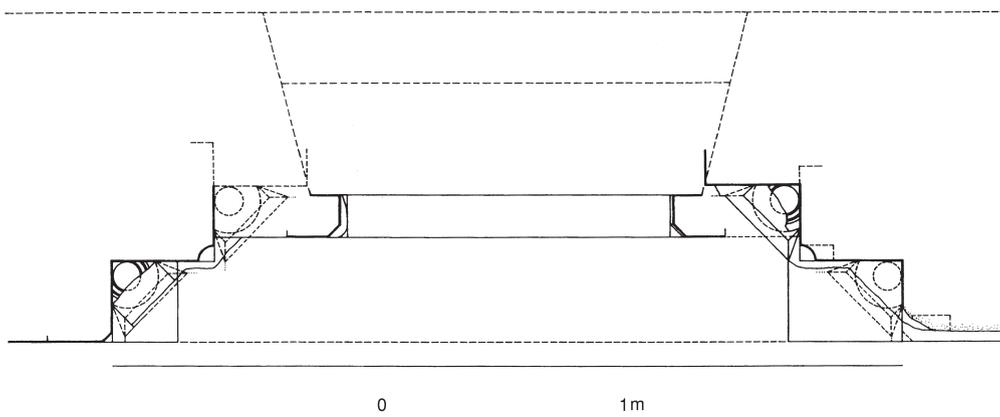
Rekonstruierter Grundriss des Nordwestportals der Franziskanerkirche zu Pozsega
